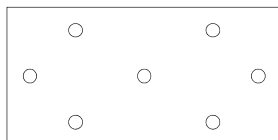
Plans de chevillage - panneaux de dimensions 1000 x 500 mm
